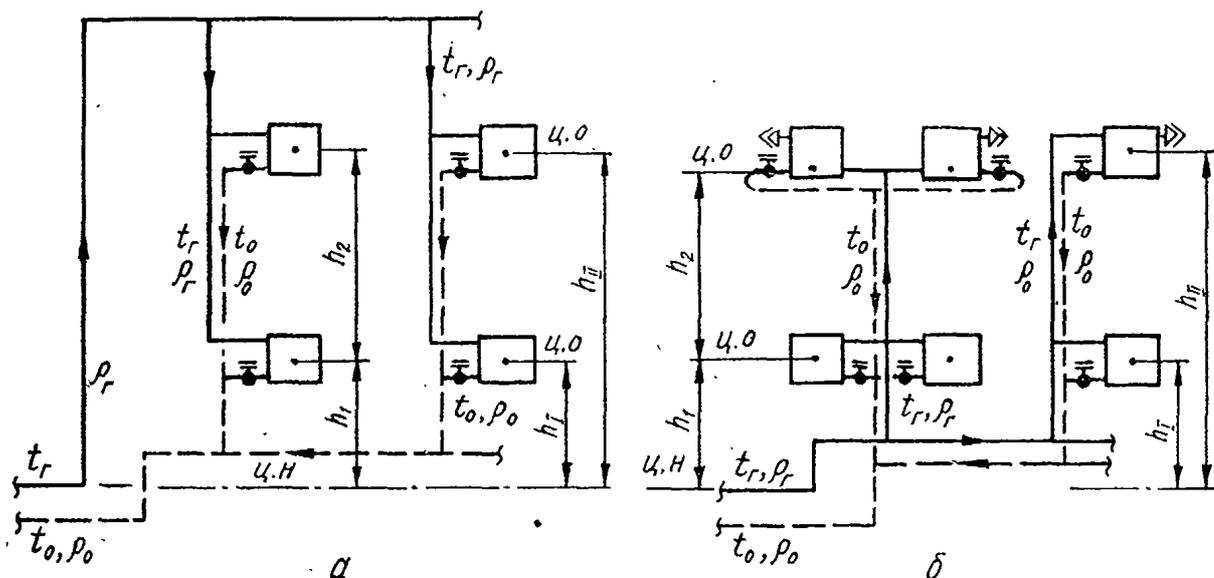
Схемы двухтрубных систем отопления: а – с верхним расположением, б – с нижним расположением распределительного трубопровода
